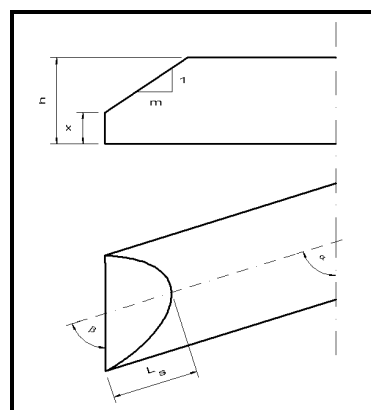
Geometrie am Schrägschnitt in Ansicht und Grundriss
